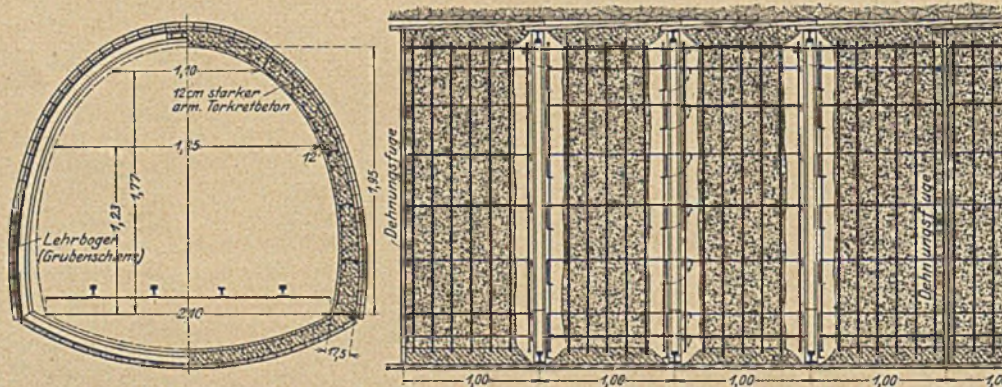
Doppelgleisiger Streckenausbau mit Grundsohle.
